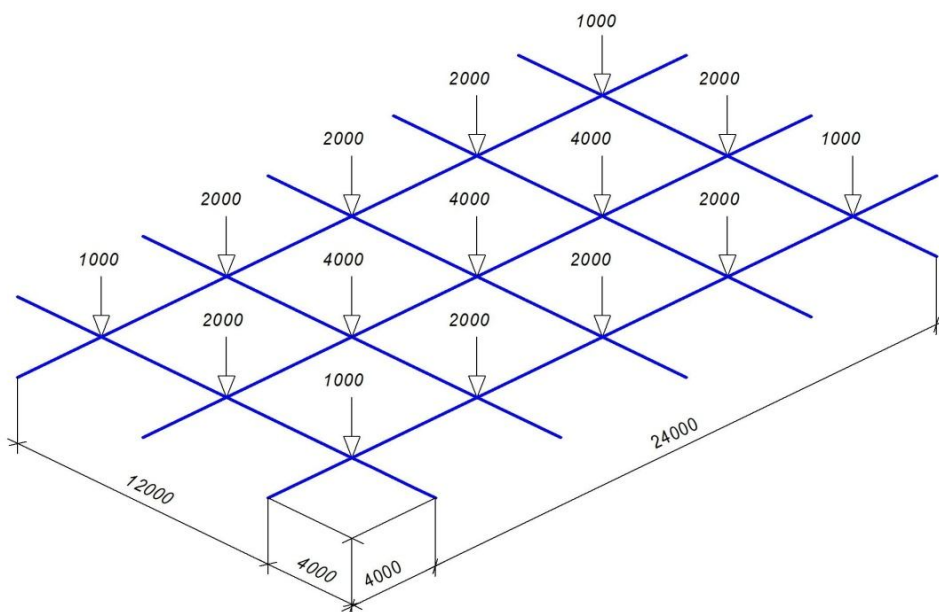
Схема перекрестного фундамента с устройством выпусков длиной 4 м, сосредоточенные нагрузки в кН
